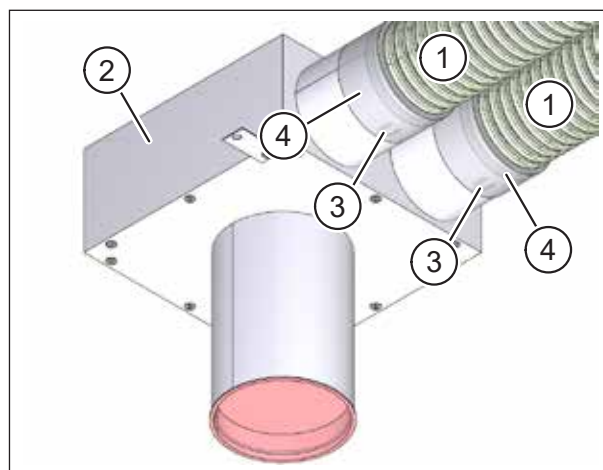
Connecter les tuyaux flexibles au caisson de plafond
